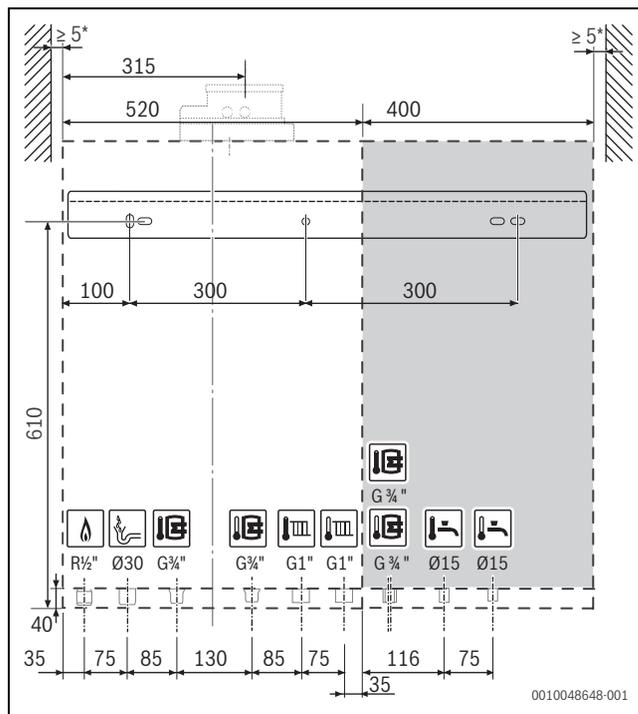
Frontansicht GB(H)192i.2-30 T40SW H (mm)
